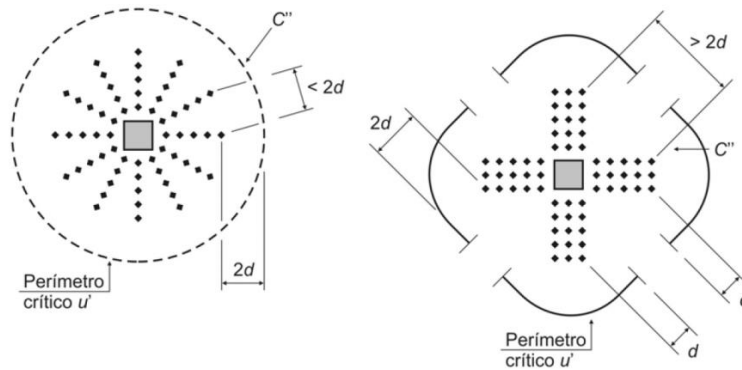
Disposição da armadura de punção em planta e perímetro crítico u_{out} em pilares internos [NBR 6118:2014 Figura 19.8]
